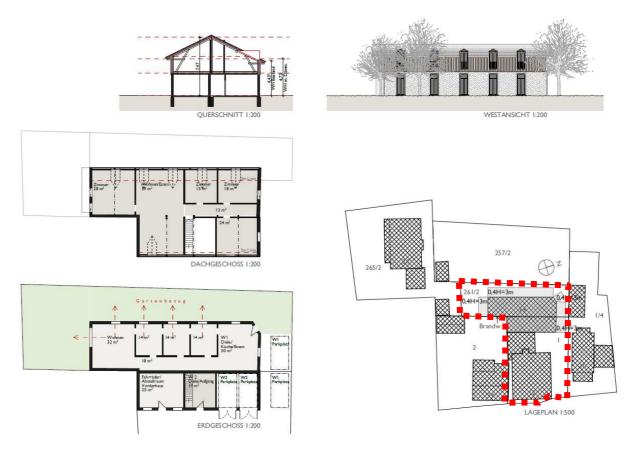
Bauantragsunterlagen – Renovierung der Remise des Wohn- und Geschäftshauses Penzberger Str. 14 (Quelle: Sunder- Plassmann Architekten)
